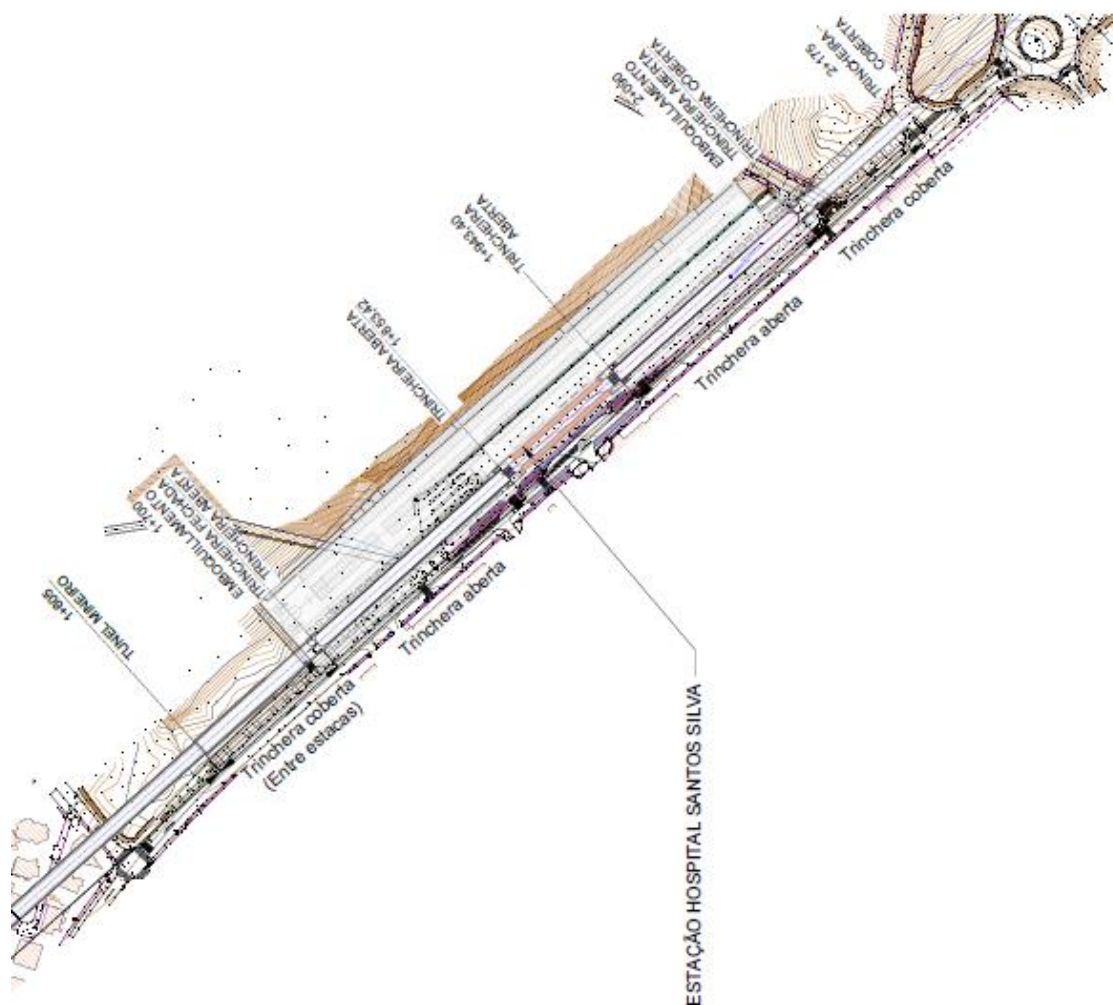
Planta Geral Estação Hospital Santos Silva
